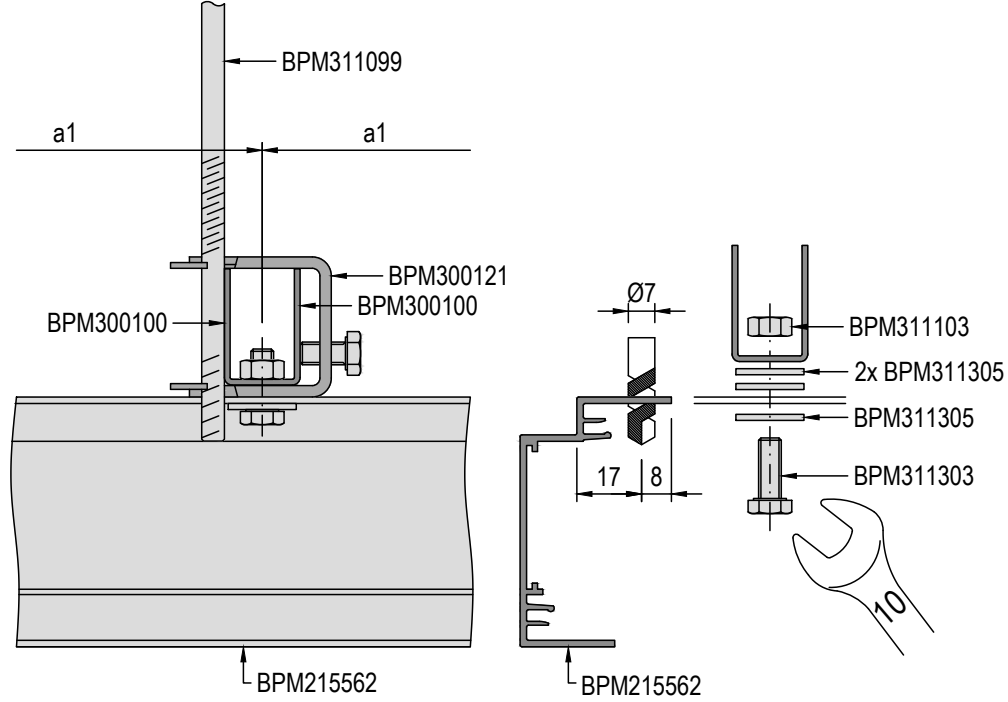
S ČÍLKEM/BULKHEAD 6"
